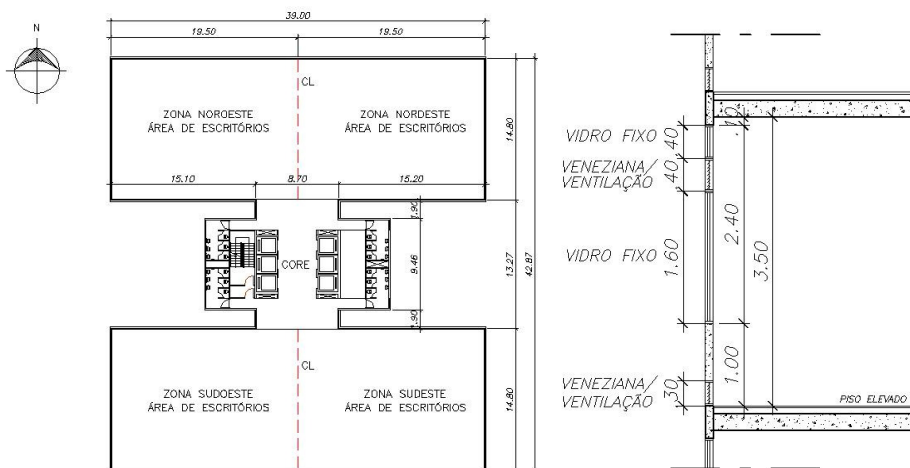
Planta e corte esquemático da fachada, M3 (WWR²=50%)
